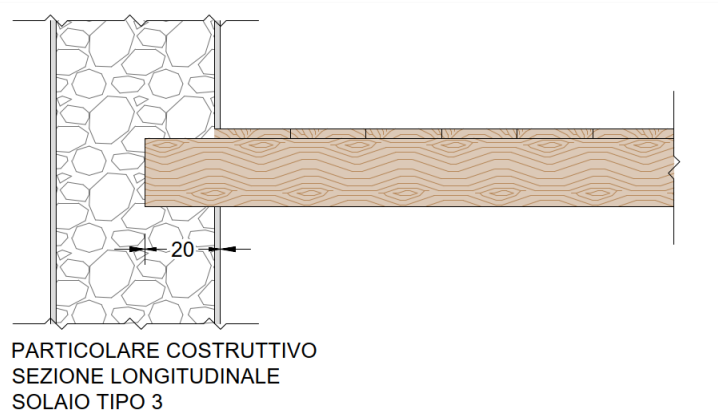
Particolare costruttivo Solaio tipologia 3 - Sezione longitudinale
